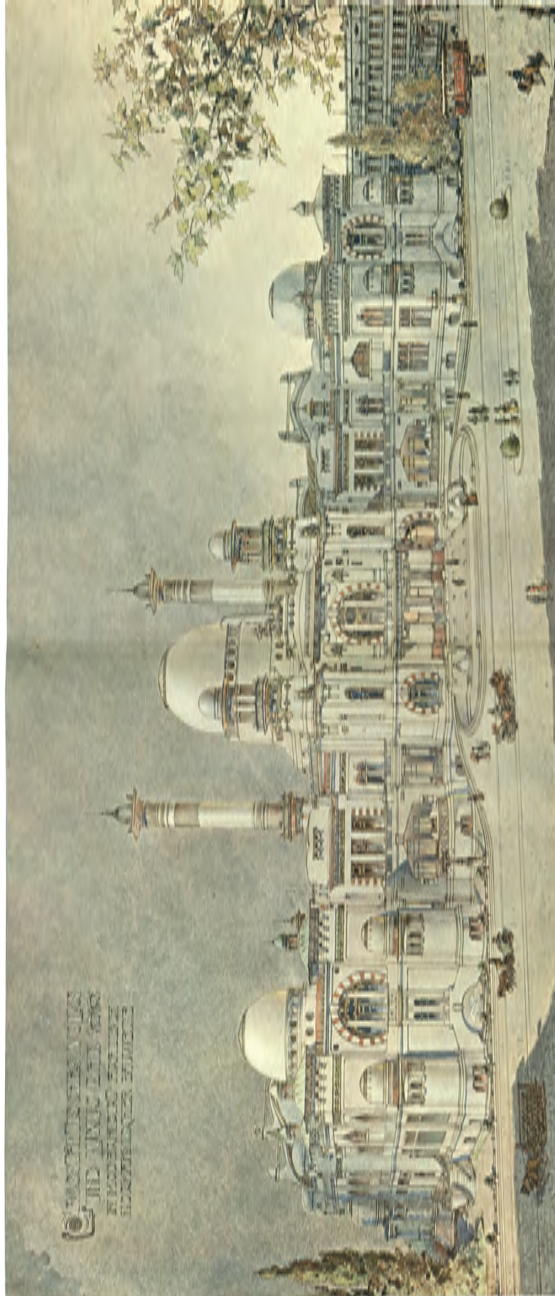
Friedrich Kick, Progetto per bagni di lusso, prospettiva esterna dell'edificio, 1903 (da Kick, *Die Baukunst in Sizilien*).
